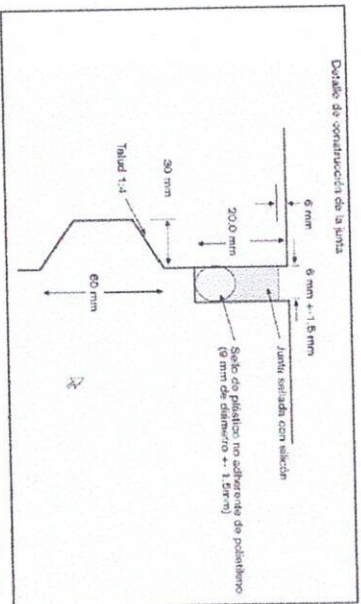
Corte y sellado de Junta Longitudinal de construcción (Tipo A)
